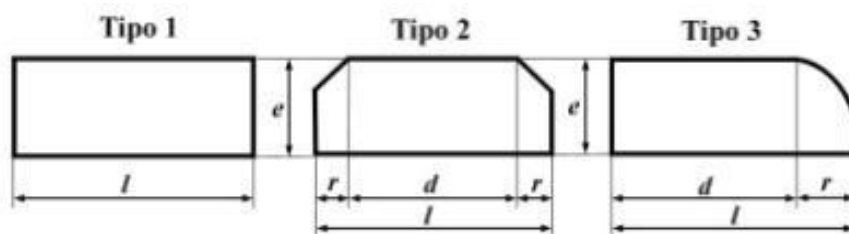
TIPOS DE SECCIONES TRANSVERSALES DE DURMIENTES DE MADERA
